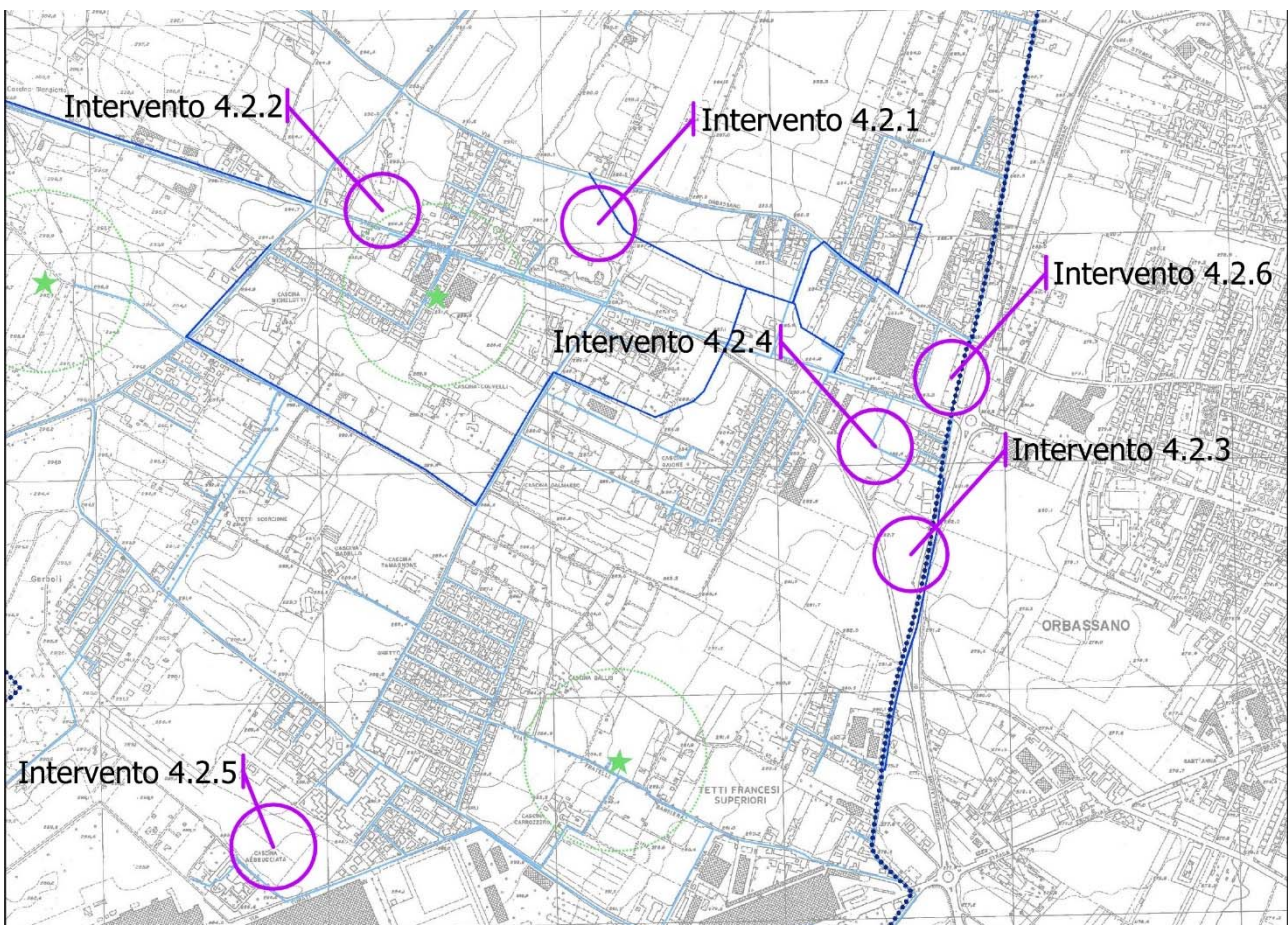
Estratto Allegato E della Relazione Illustrativa. Rete idrica – Sud Sangone
